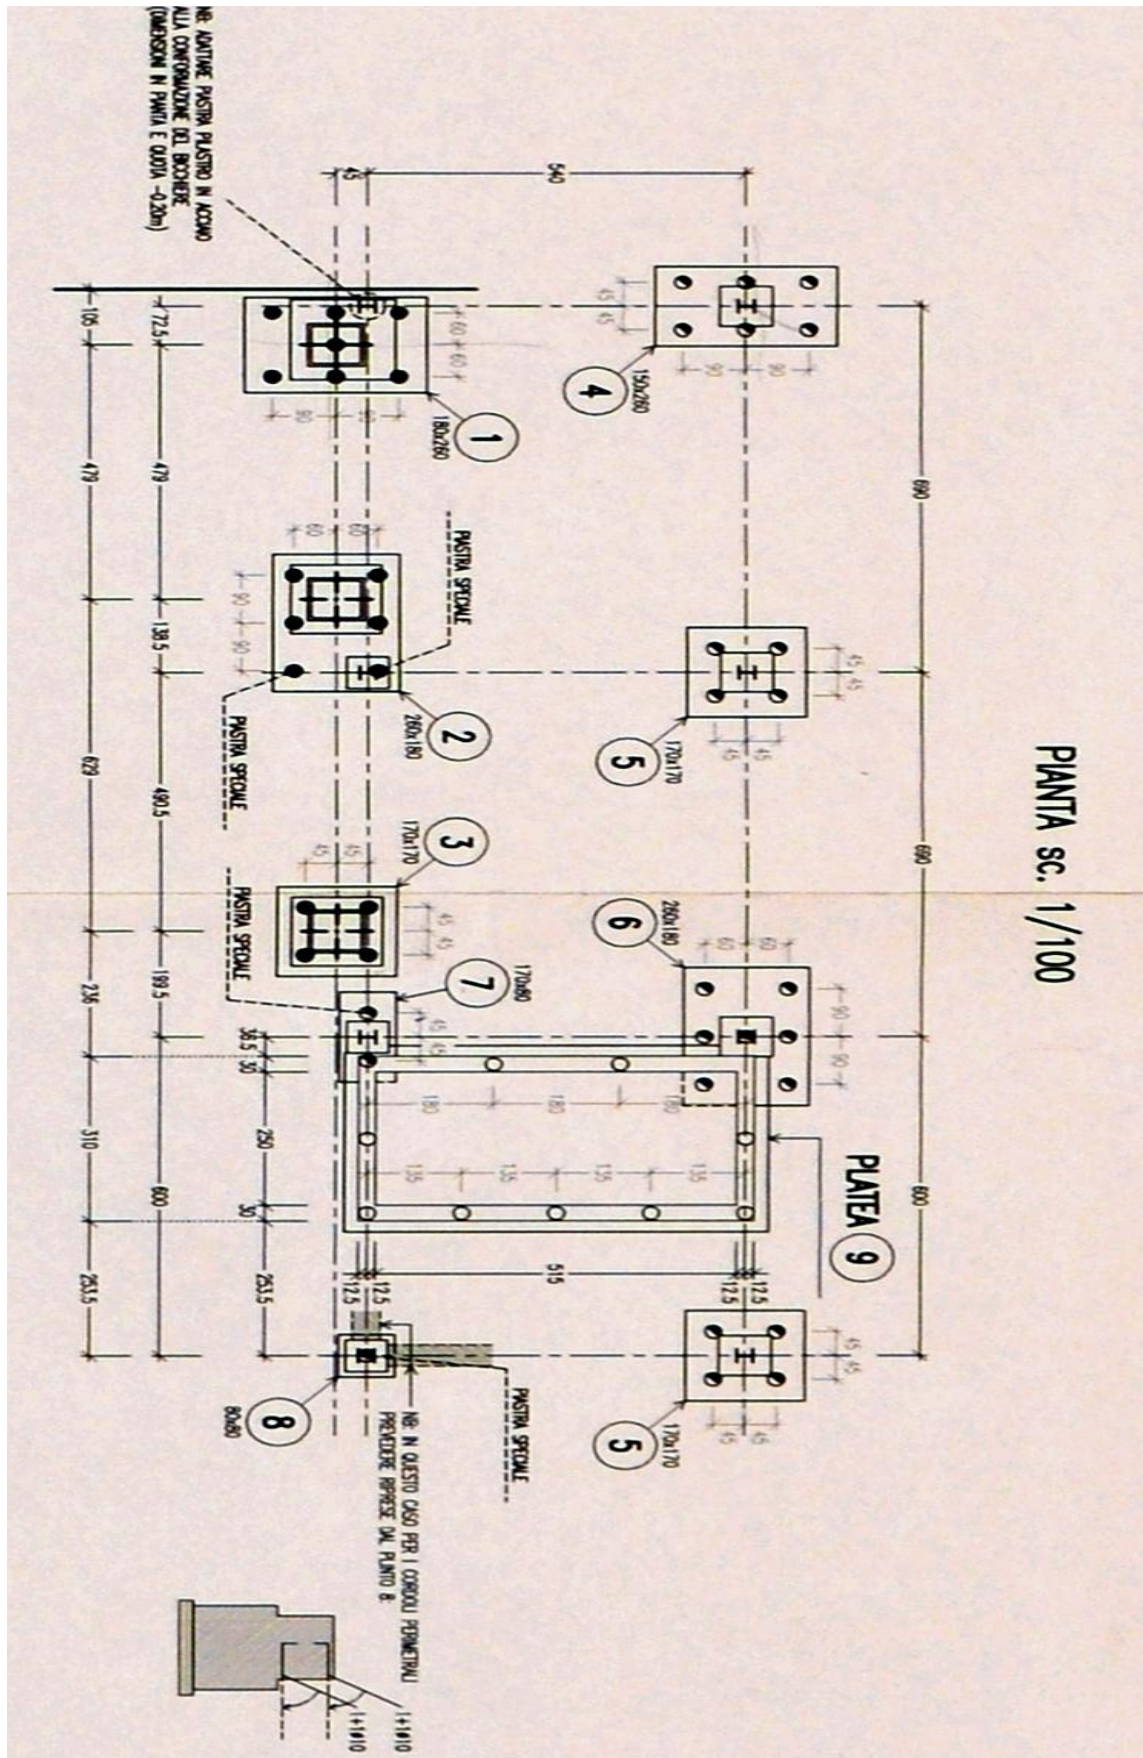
Particolare di A.2003.a.us.c.T01 - Pianta delle fondazioni - Pianta
